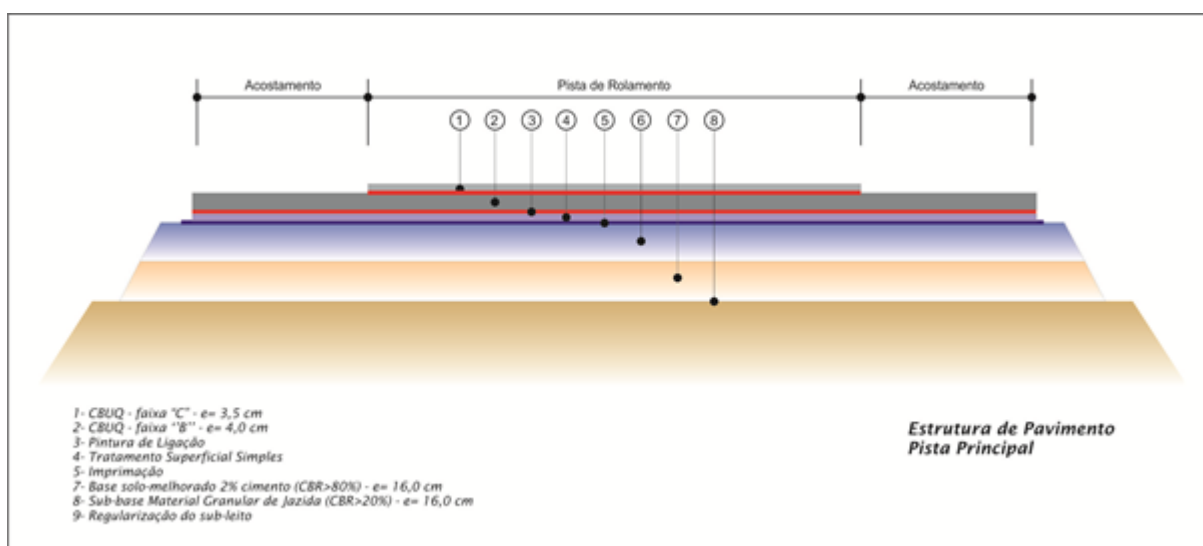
Estrutura de pavimento projetada para o Arco Viário e Interseção 01
